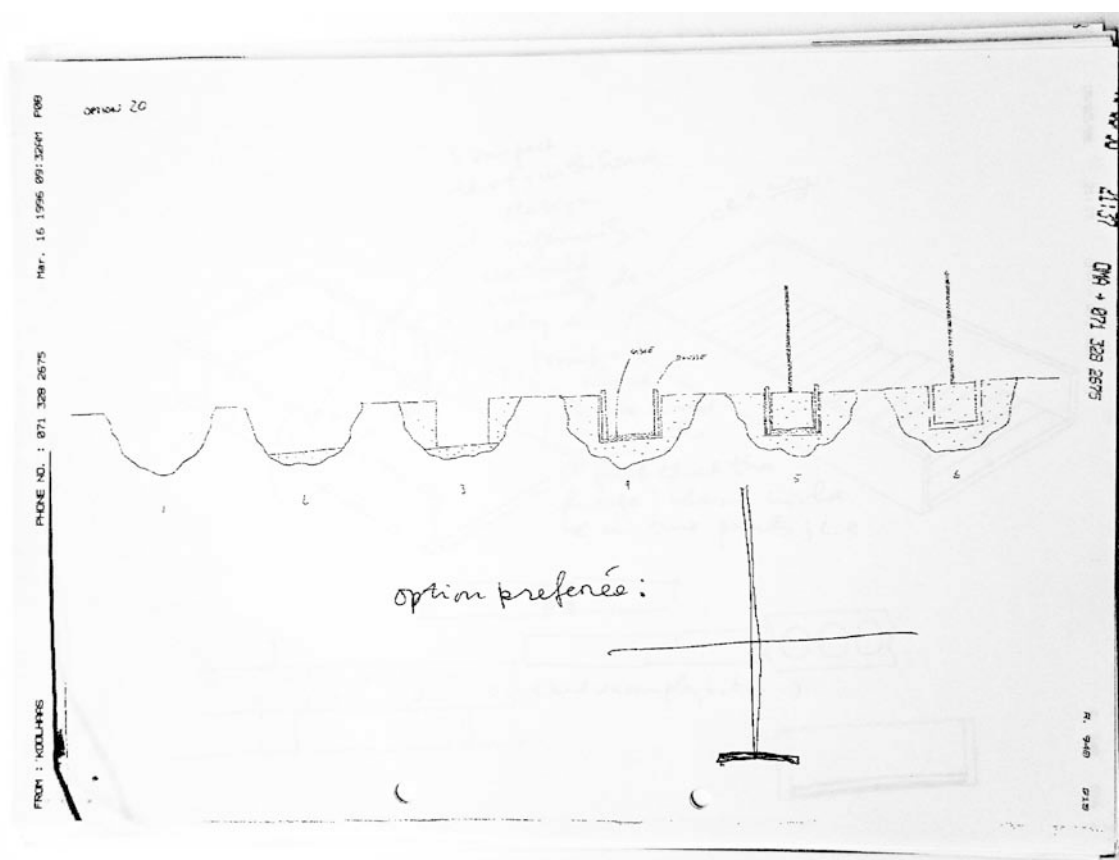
Croquis de anclaje estructural de tirante con anotación de R.Koolhaas. Fax de obra 16/03/1996
